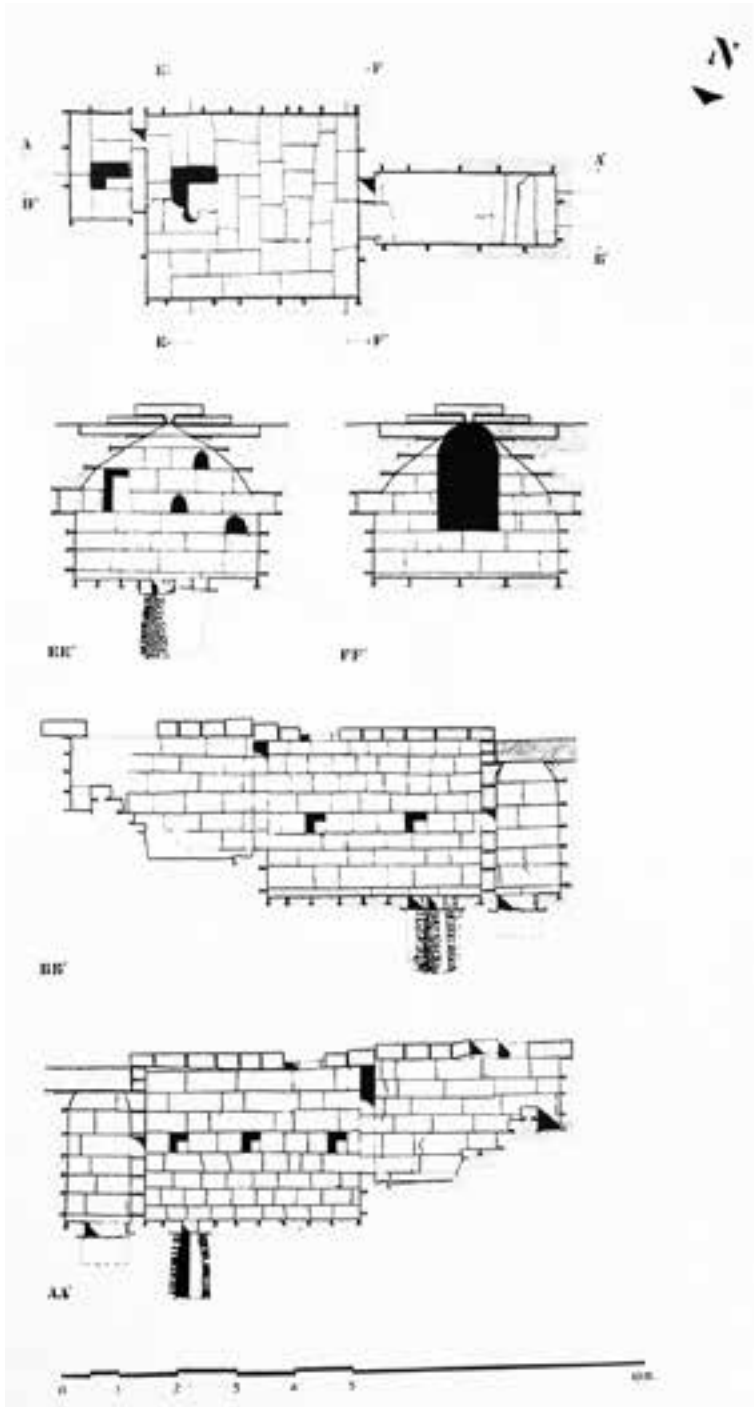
Planimetria e prospetti di tomba a camera costruita (da SALLES 1995, fig. 18.2)
